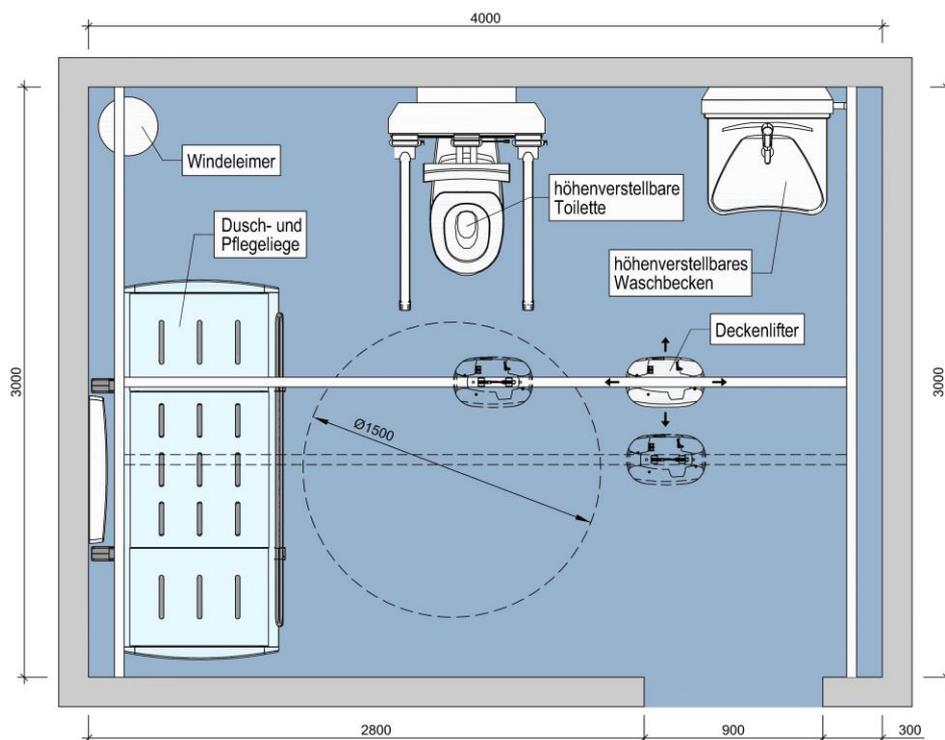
Beispiel Grundriss „Toilette für alle“.
